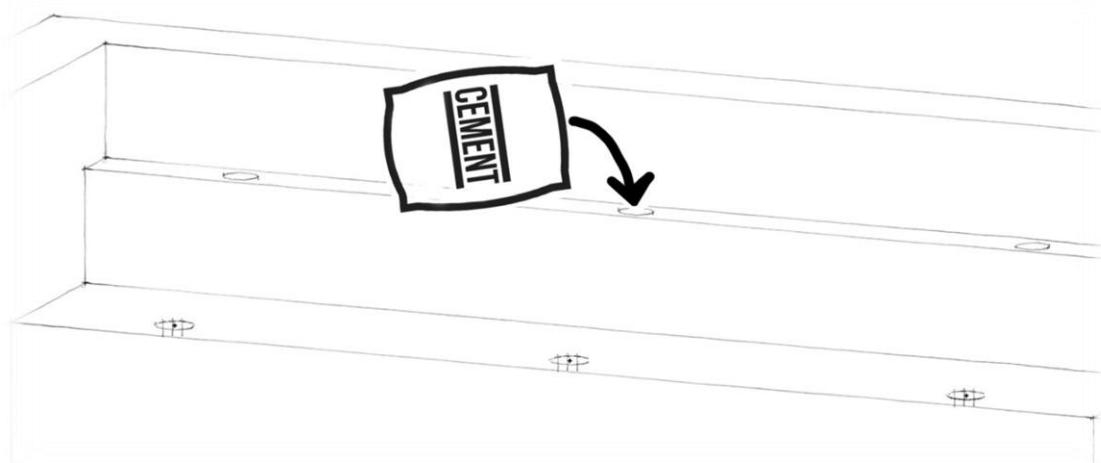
Remplissage des zones de contraste et soutien des jambes
